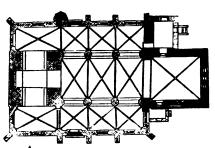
Lassan. S. Johanniskirche. Grundriss, 1:667.
